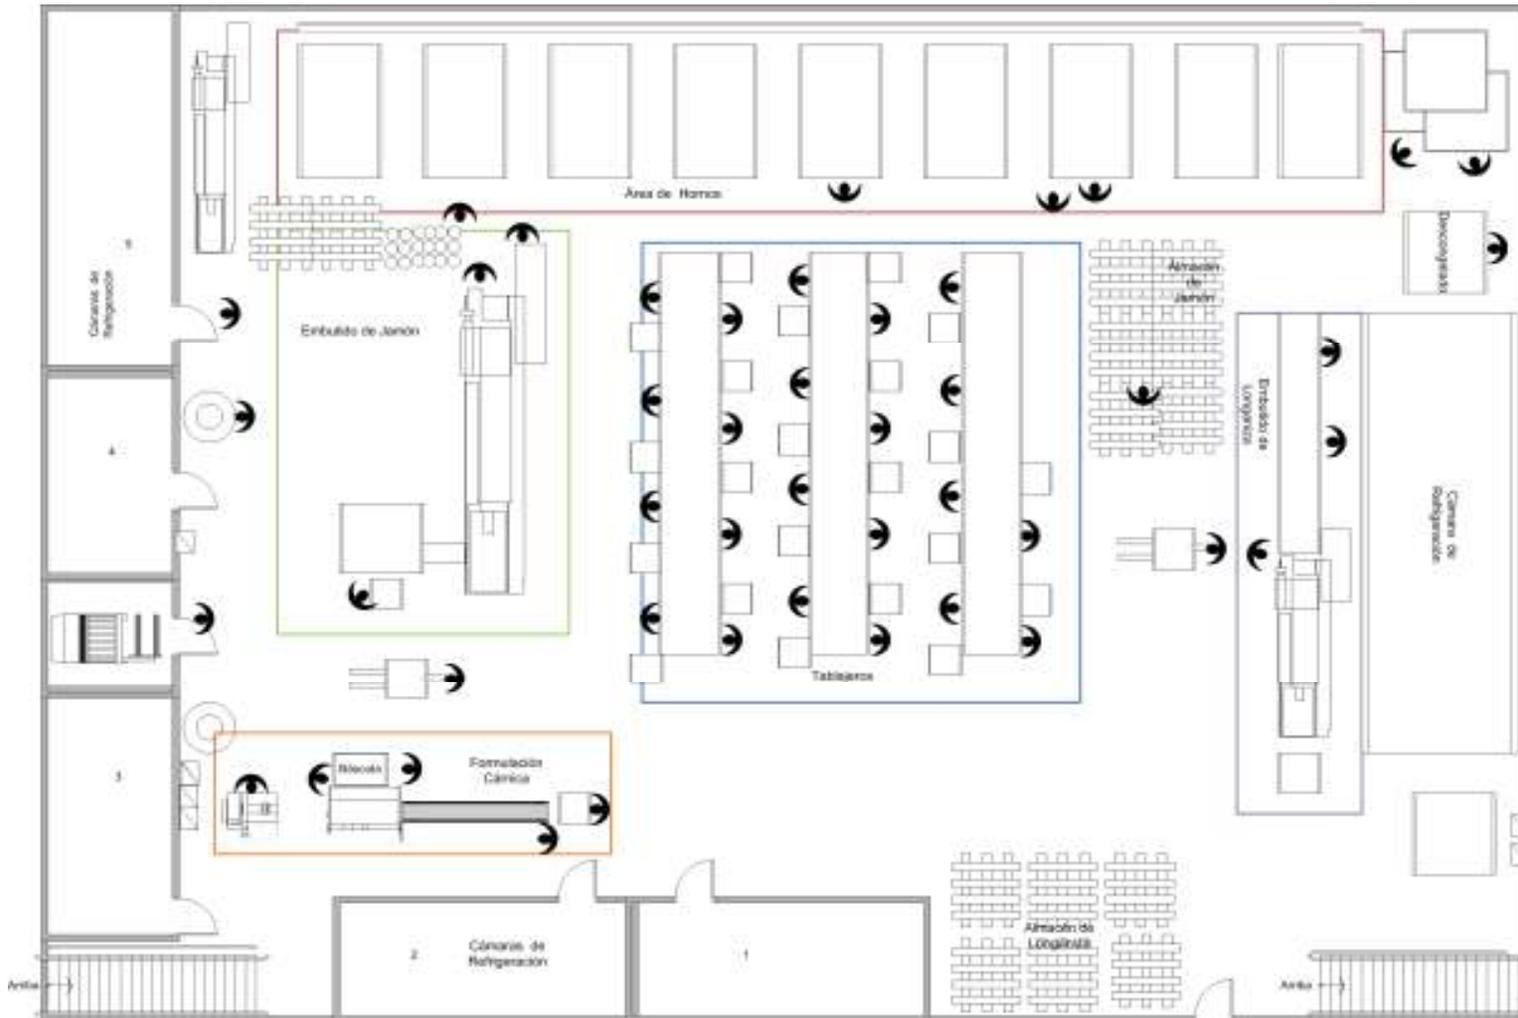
Planta baja de Valle de Bravo 3 (Área de producción)
